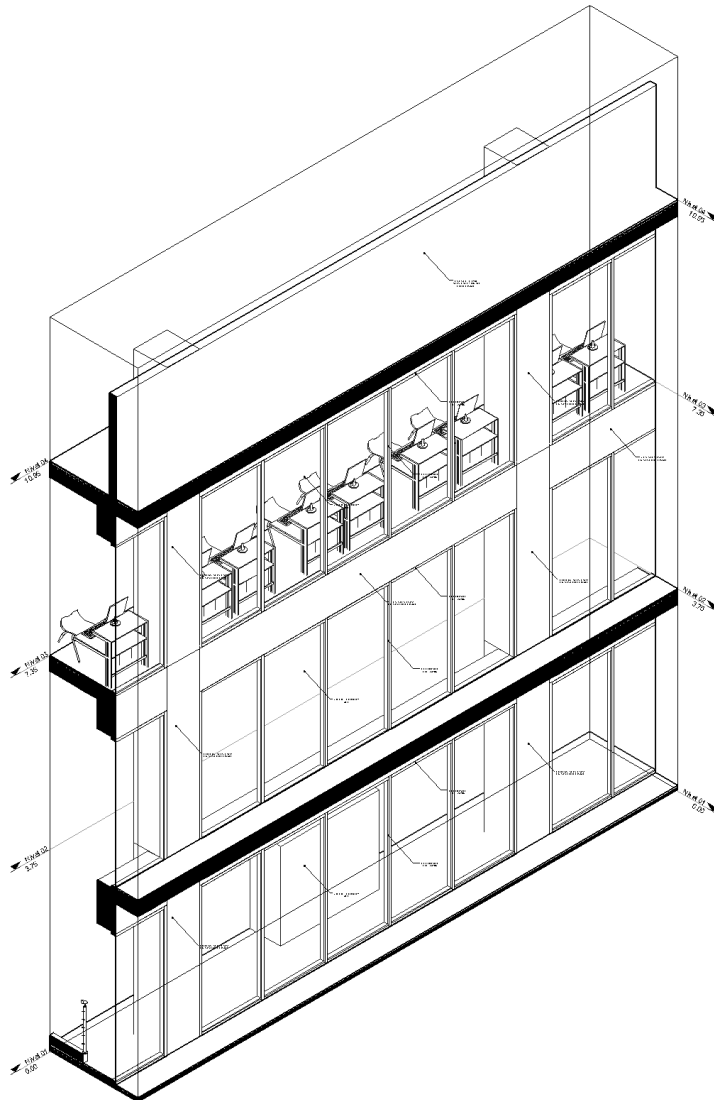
Vista de muro cortina. Fuente: elaboración propia.
